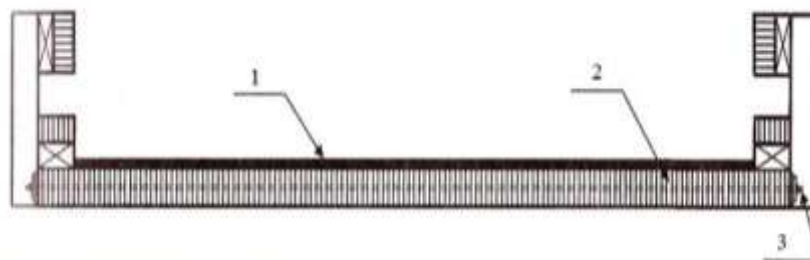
Конструкція плитної прогонової будови з обтиснутої дерево-плити: 1 – асфальтобетонне покриття; 2 – поздовжня обтиснута дерево-плита; 3 – напружений стержень
